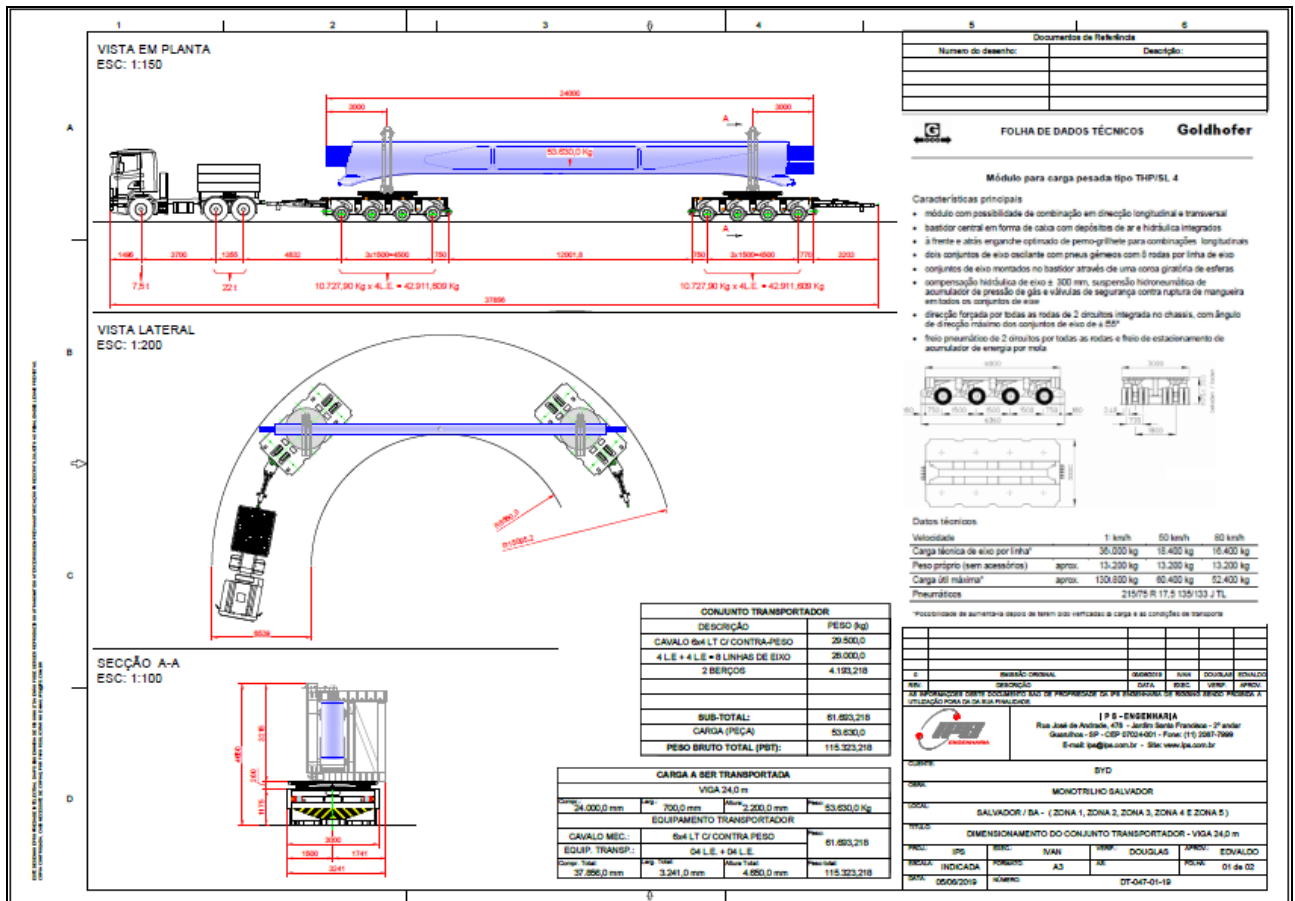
Dimensionamento do transporte das vigas pré-moldadas.
